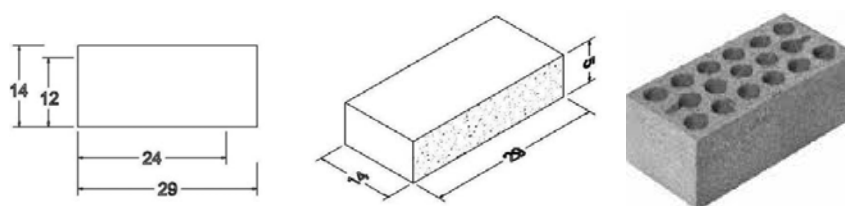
Ladrillo macizo de Hormigón normal y ladrillo de hormigón perforado.
